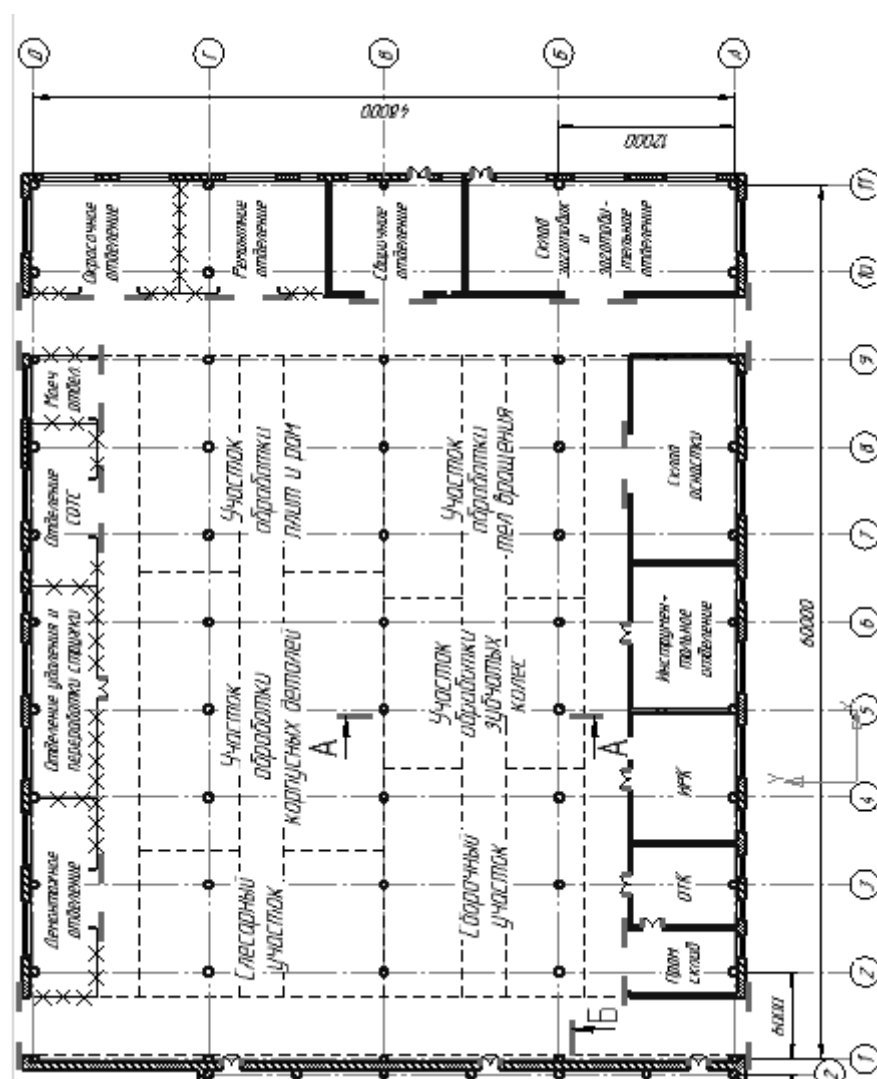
Пример компоновки механосборочного цеха для условий серийного производства
